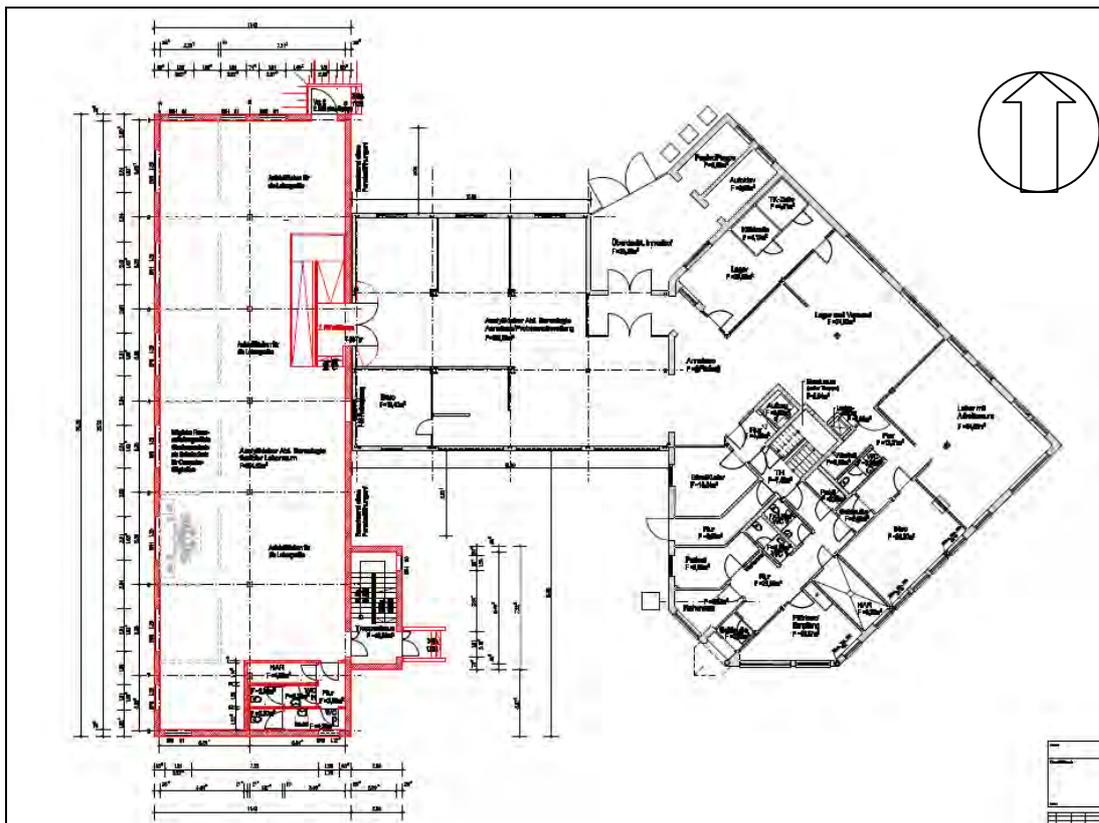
Beispiel für den Grundriss (hier Erdgeschoss) des geplanten Erweiterungsbaues. Vergleiche hierzu auch die Zeichnung-BI.-Nr. 1 und 2. (Entwurf und Zeichnung: RIK – Kathleen Gerth)
